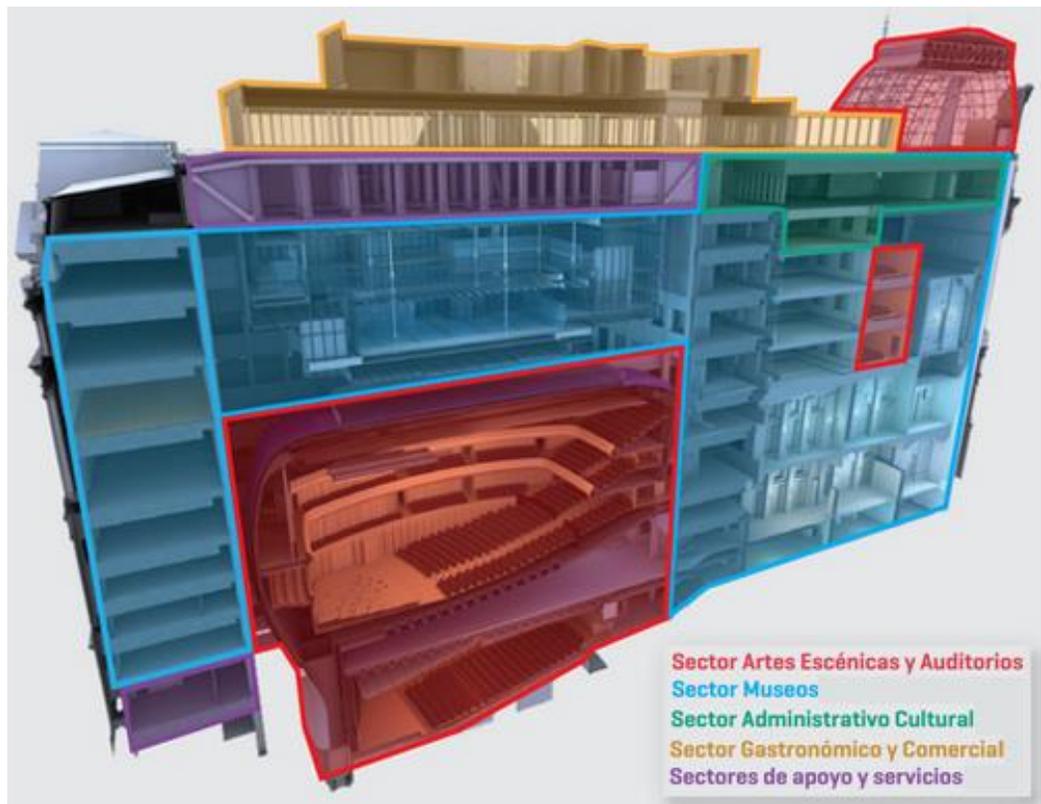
Distribución de sectores – Centro Cultural Kirchner
